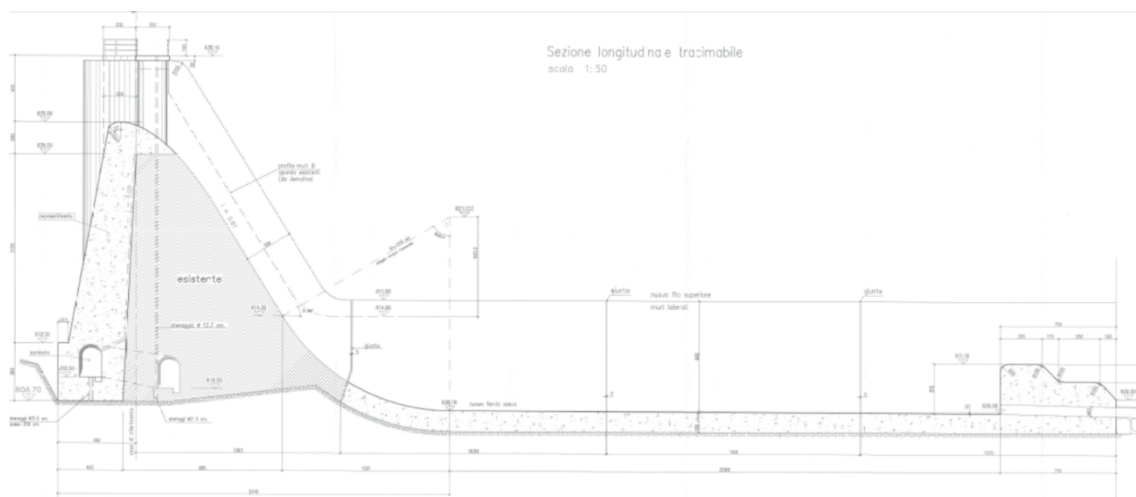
Sezione longitudinale trascinabile tratta dal dis. 980.003.742 rev 01 del progetto approvato
